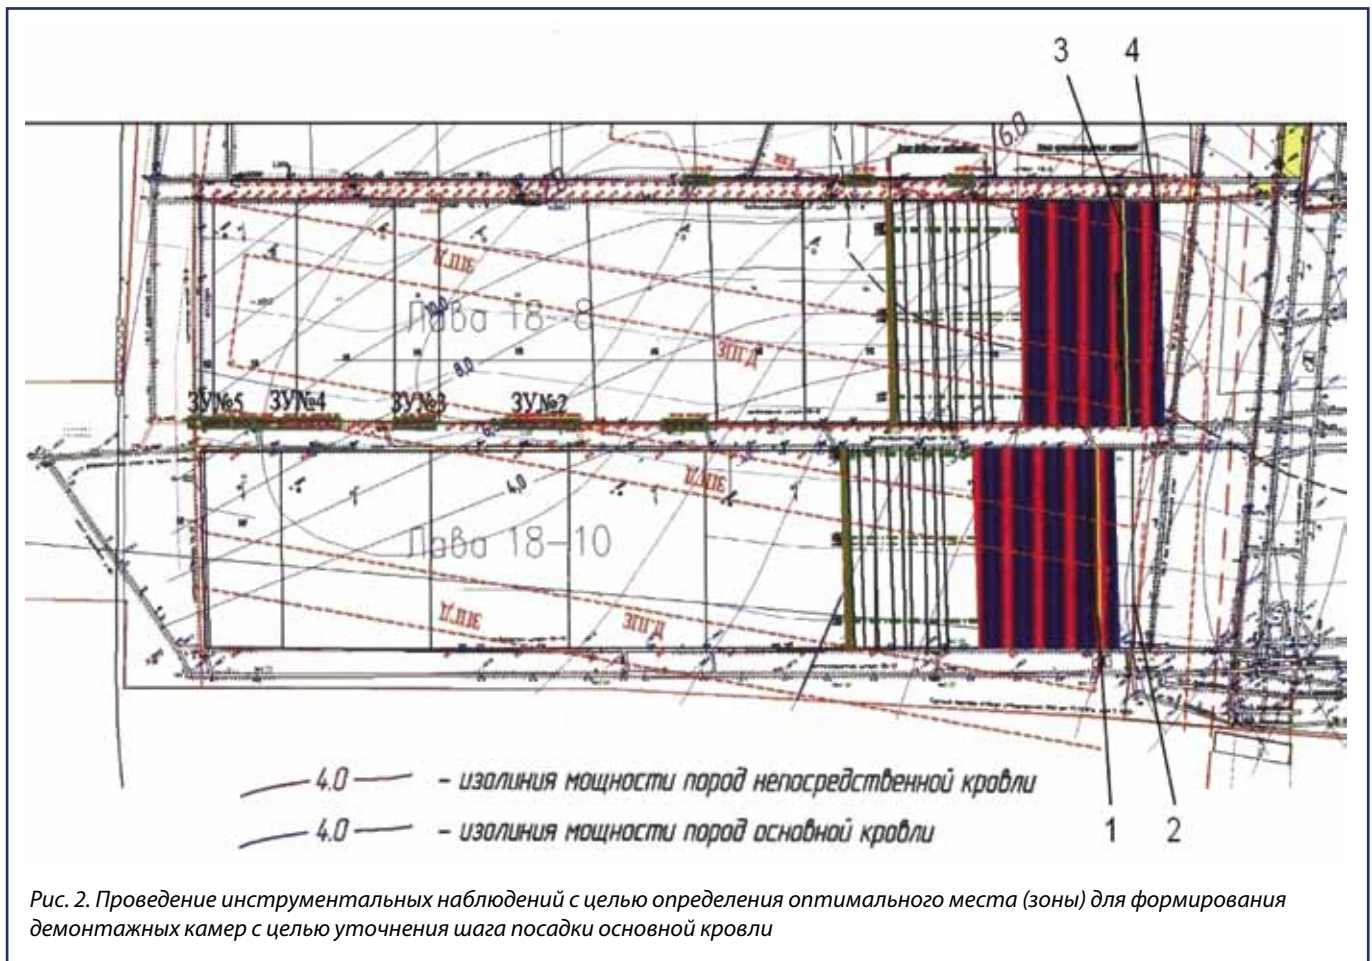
Проведение инструментальных наблюдений с целью определения оптимального места (зоны) для формирования демонжных камер с целью уточнения шага посадки основной кровли
